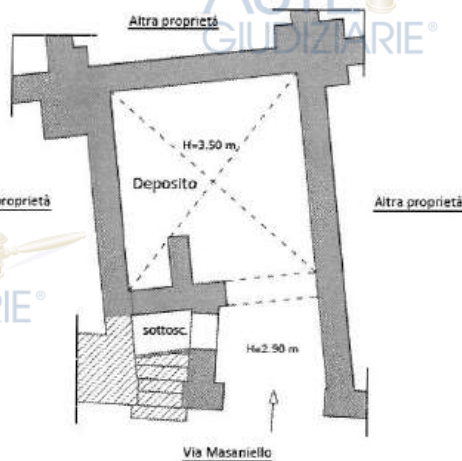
Planimetria dello stato reale dei luoghi - Locale Deposito (Piano Terra)
